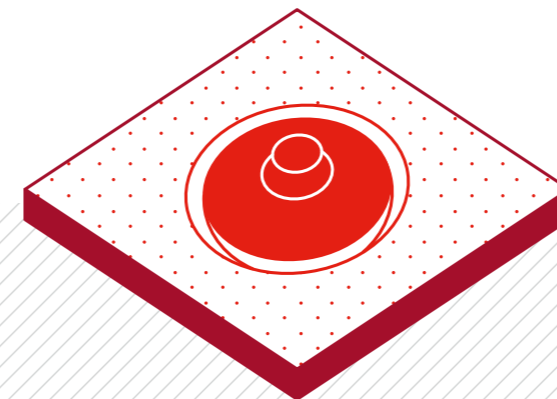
Schéma d'une fondation d'éolienne (source : EDPR)
